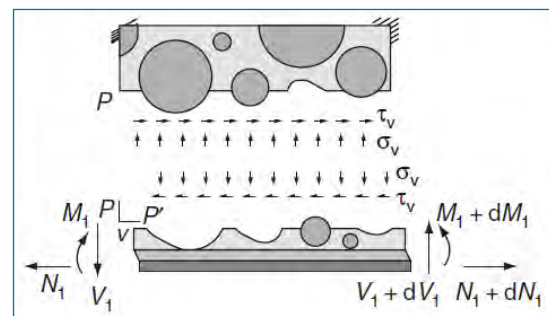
Modell für das Versagen des Betons mit einer aufgeklebten Lamelle
